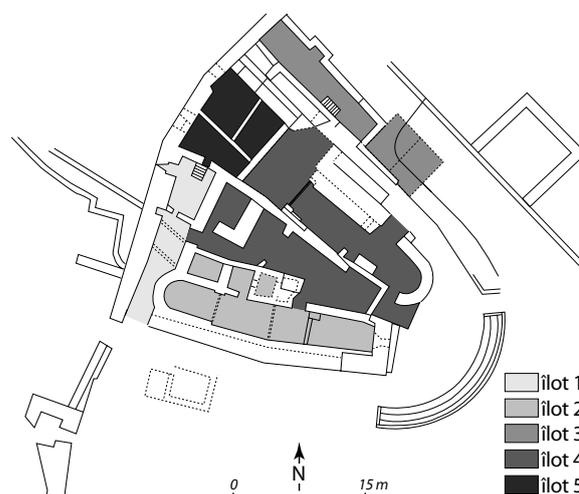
OLLIIOULES, château. Plan des vestiges (d'après le plan de Félix Martin, architecte DPLG).
